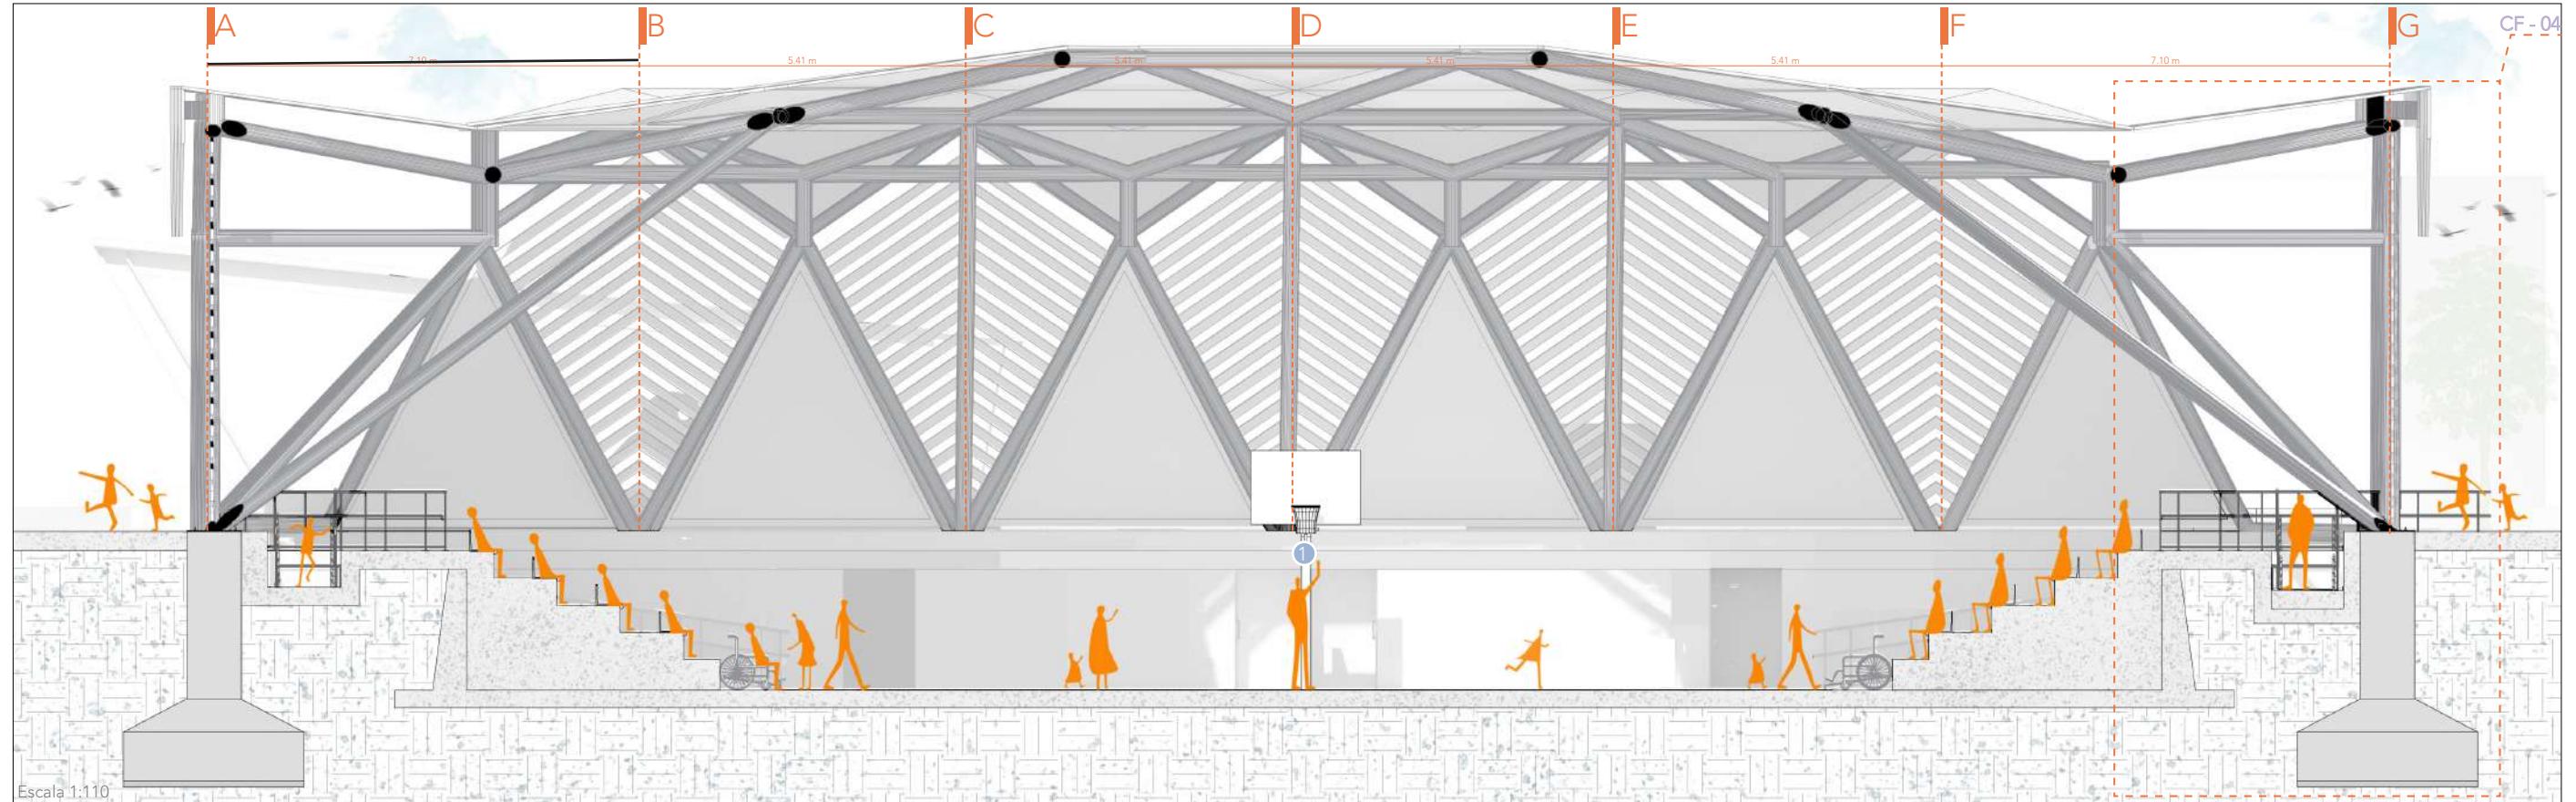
Corte B - 'B, Coliseo. Elaboración propia, 2024.
